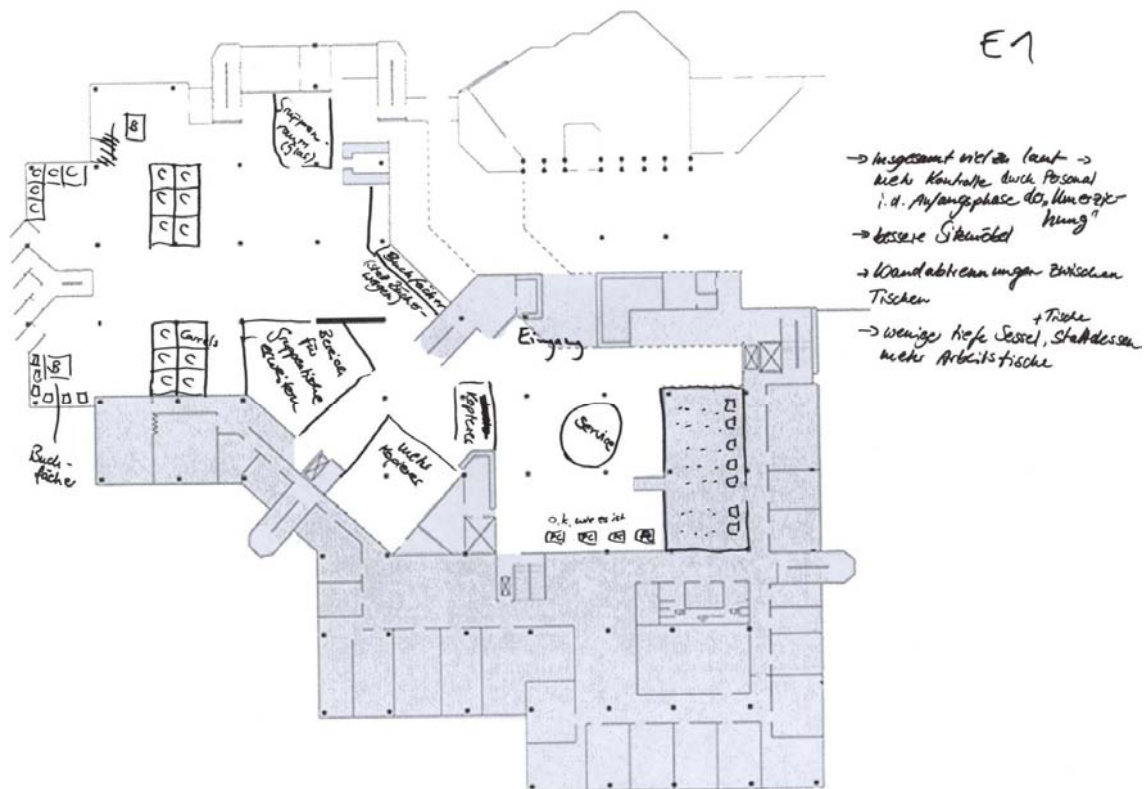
Grundrissplan der Ebene 1 (Andrea)
